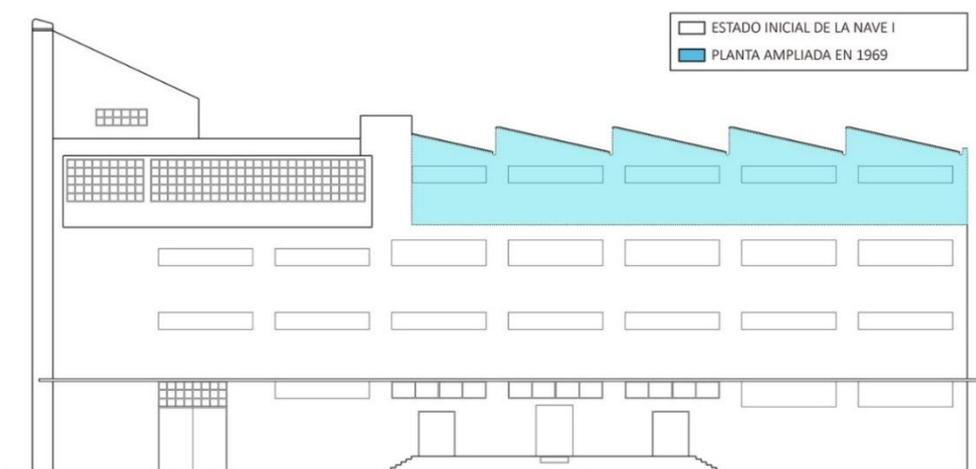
Esquema en alzado (fachada noroeste) de la ampliación de una planta en la nave I. Fuente: elaboración propia.
